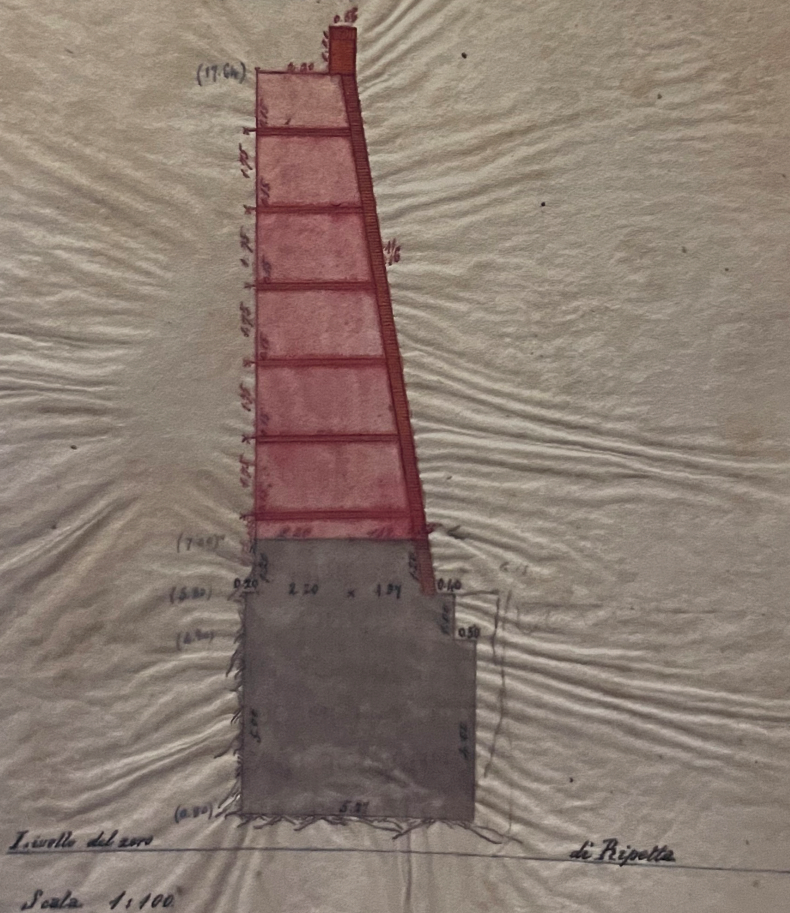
“Sezione Tipo del Muro di Lungo-Tevere alla sez. N°1”. Progetto di completamento dei lavori di sistemazione con muraglione della sponda sinistra del Tevere nella località detta la Regola [...], 9 gennaio 1877, Allegato 5. ASR, USTAR, b. 61.
